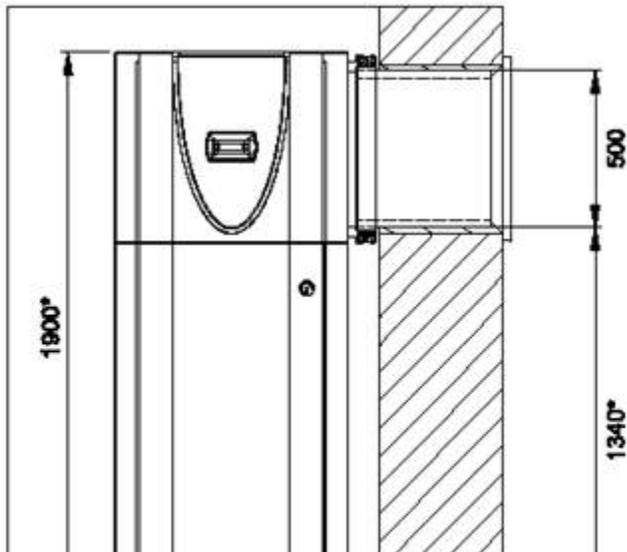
Vista dall'alto - LIK 8TES (installazione ad angolo)
